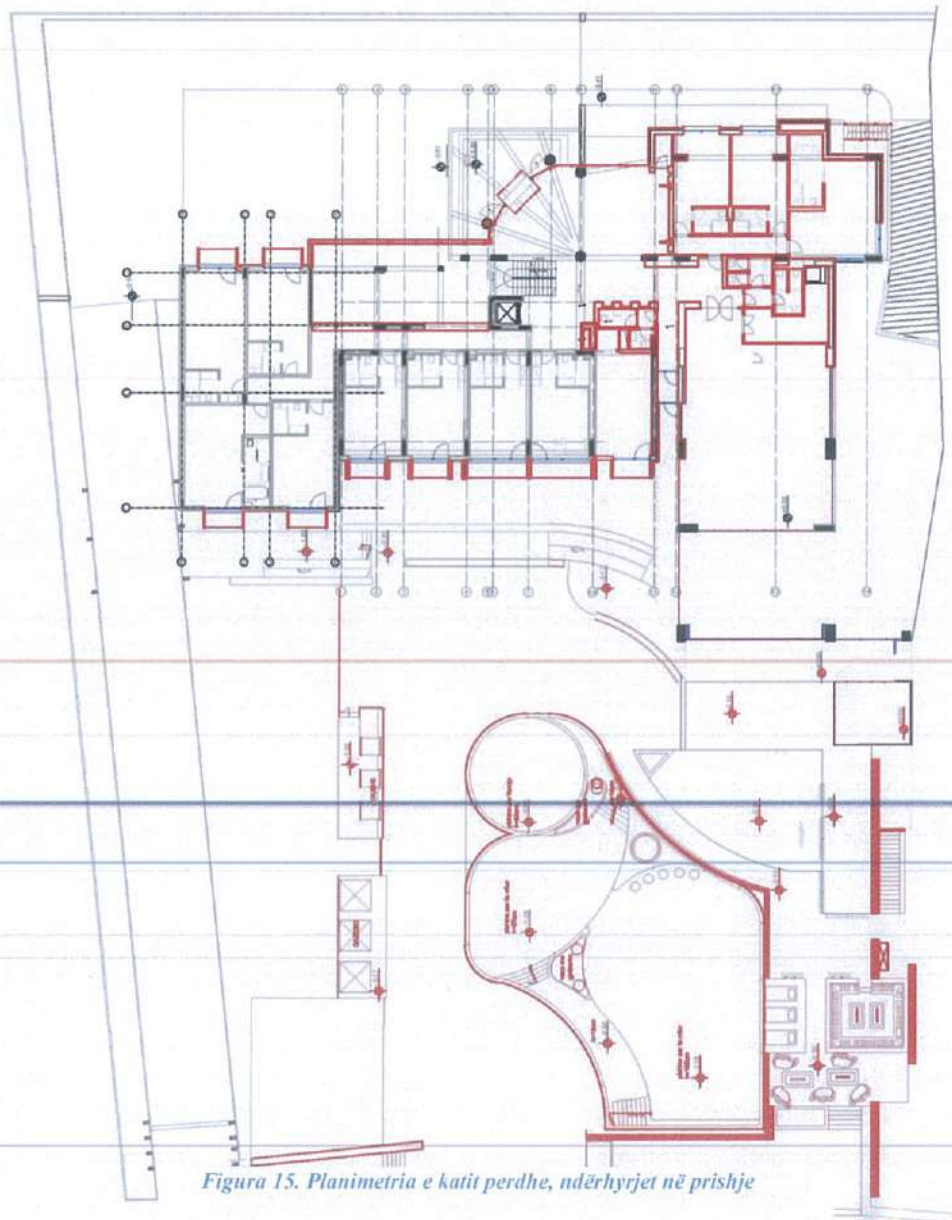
Planimetria e katin perdhe, ndërhyrjet në prishje
